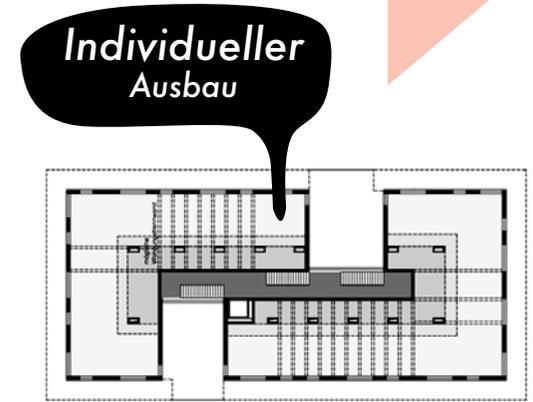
Grundriss mit Flächen für die Position von Küche/Nasszelle für individuelle Gestaltung ("Wohnprojekt Wien", o.J.)
